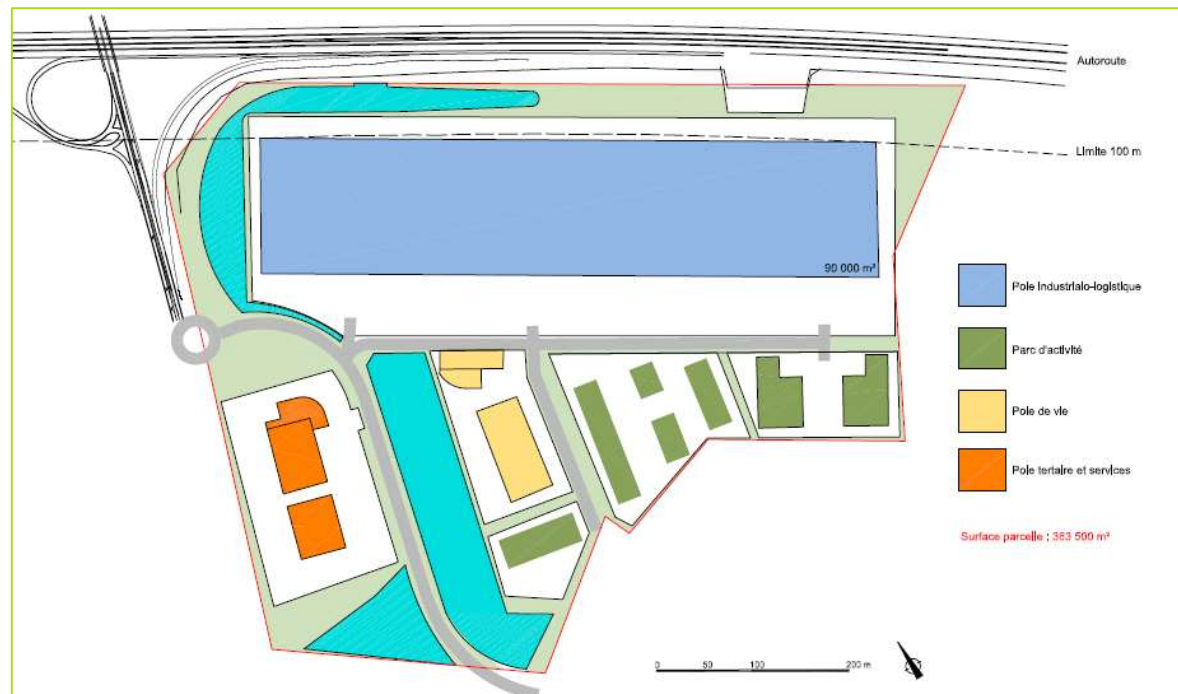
Plan masse du 25 janvier 2022 (Source : Espace Libre/SUEZ Consulting)
